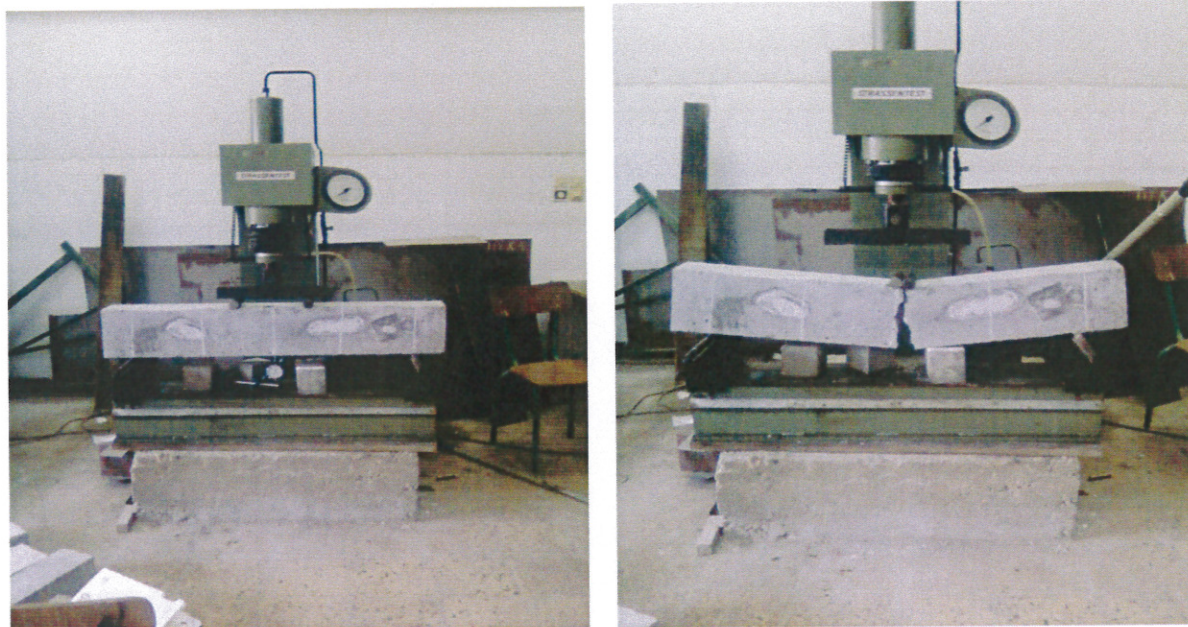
Essai de Traction par Flexion sur une poutre (15x20x120)
